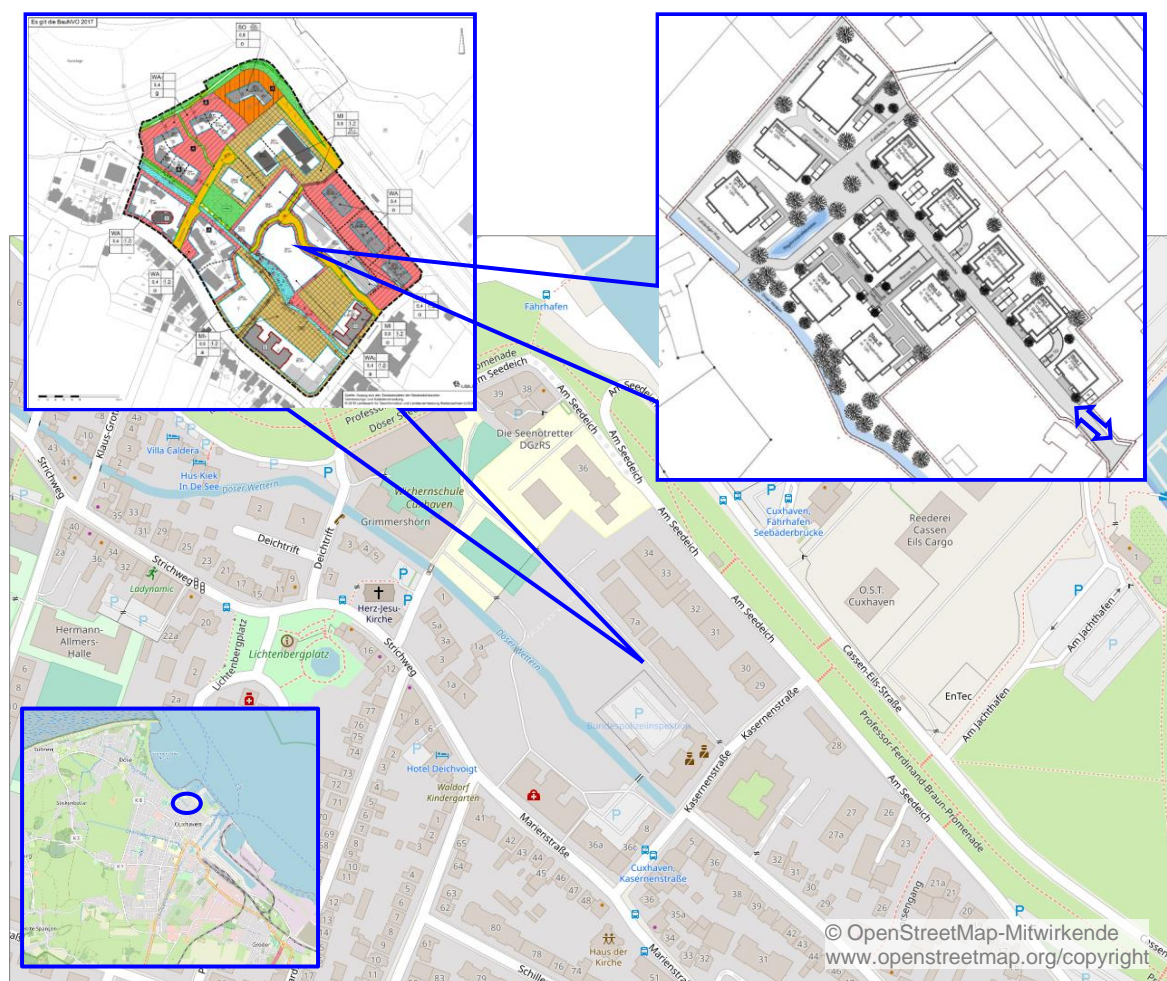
Übersichtslageplan (© OpenStreetMap-Mitwirkende, Planausschnitt [1])
